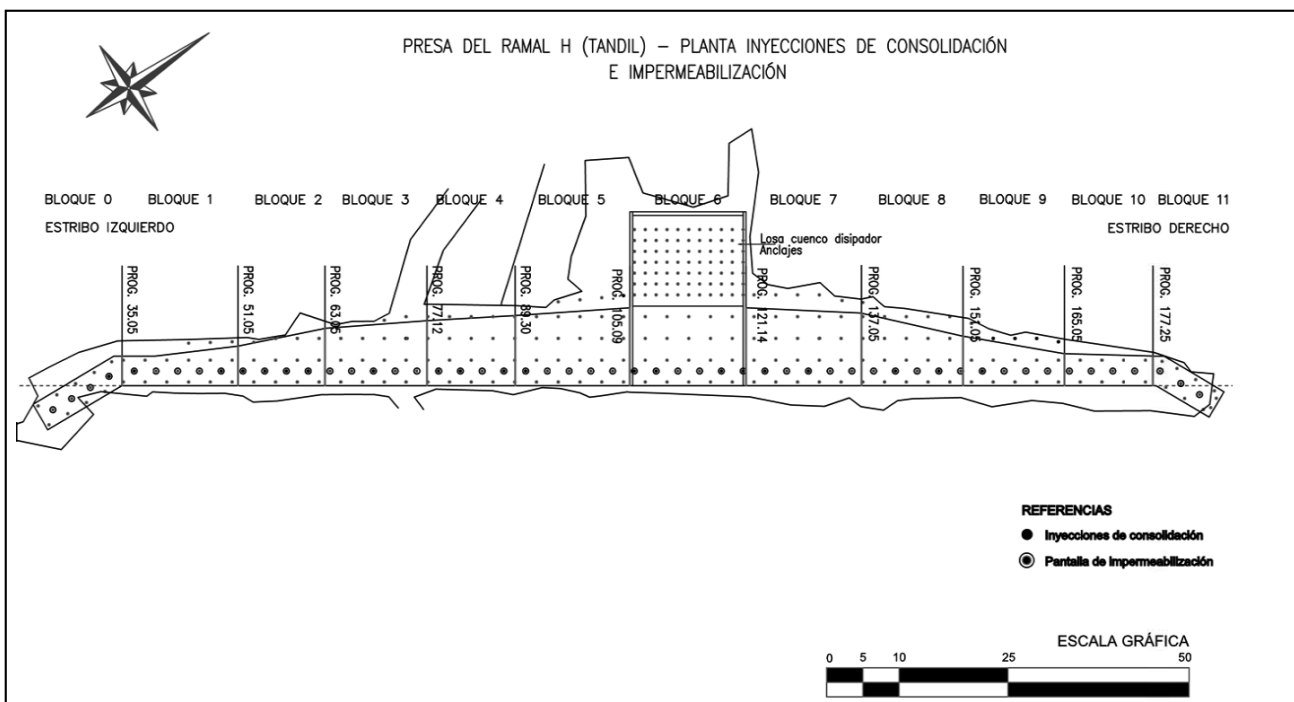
Ramal H - Planta - Plano de inyecciones primarias
